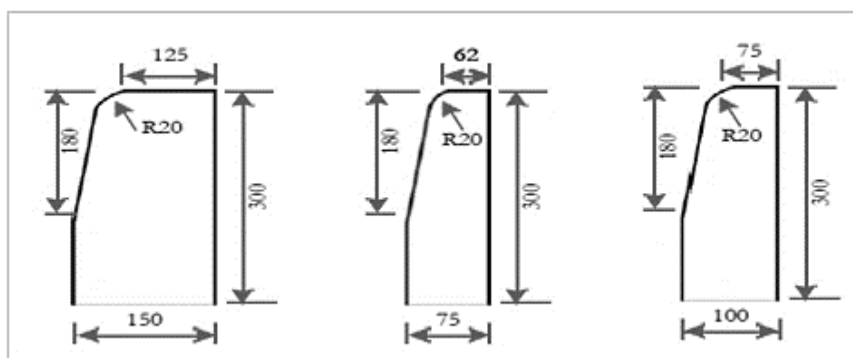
Tipos de lancis verticais tipo barreira Block Block 3 (Fonte: CMA, 2009).
